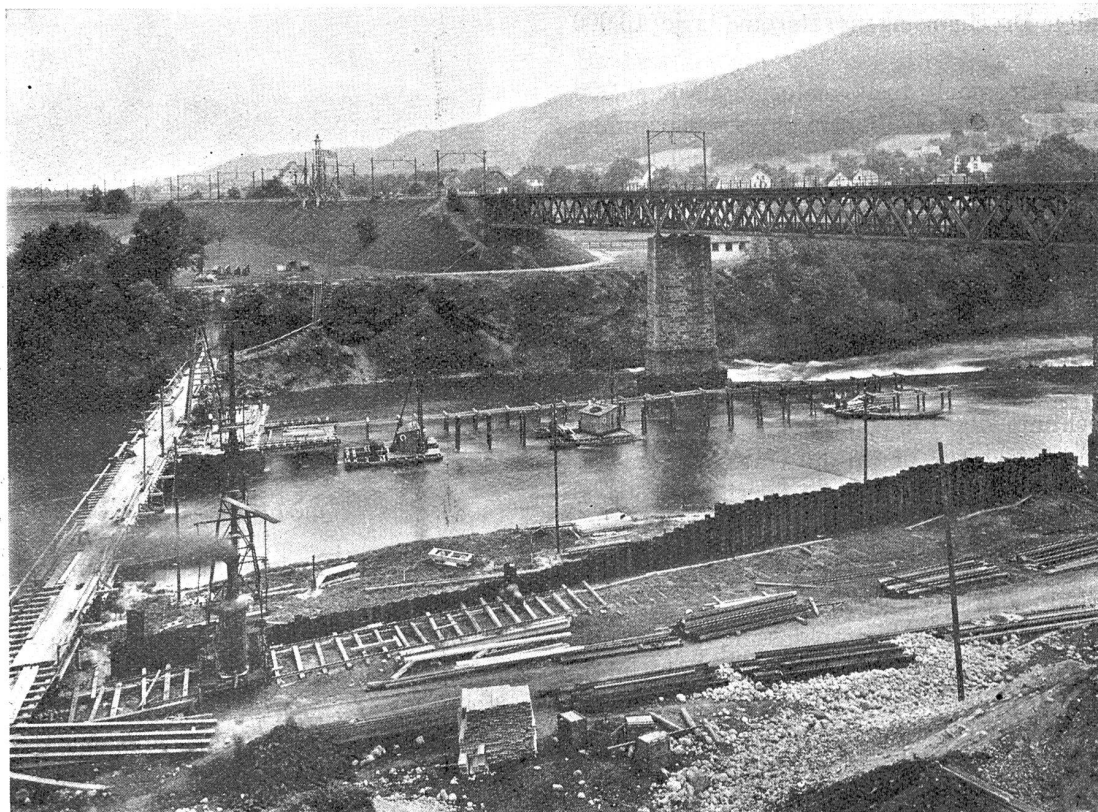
Kraftwerk Wettingen. Stauwehr, Installationen, Dienstgerüst, Schutzgerüst über Eisenbahnbrücke.
